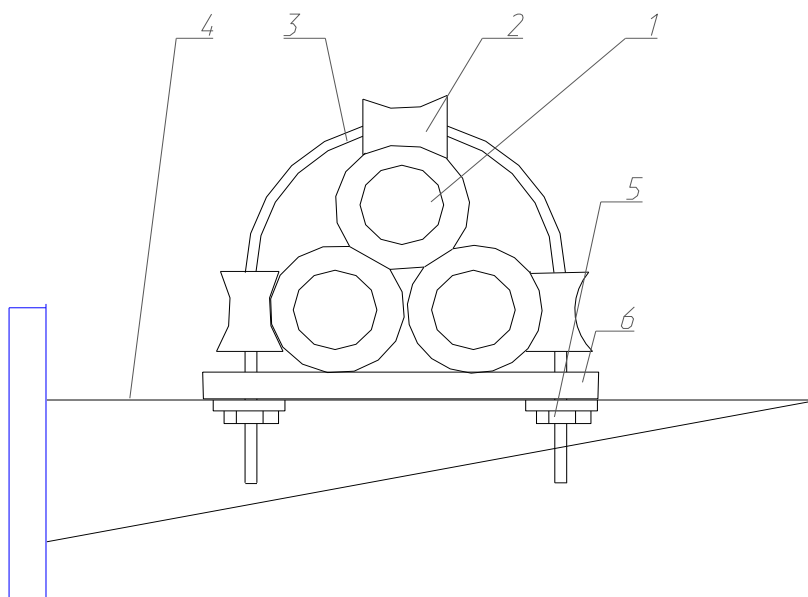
Вариант крепления кабеля с помощью клиц (треугольник).
